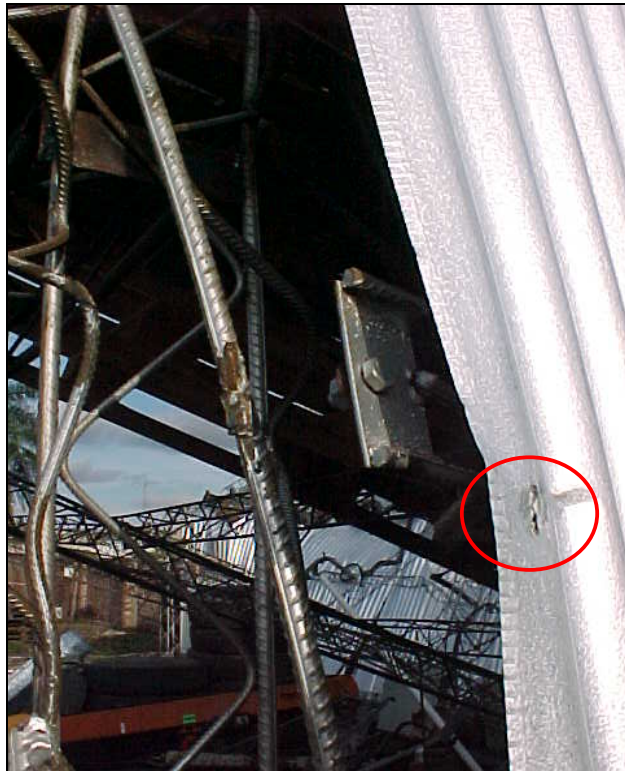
Falla en acero para hormigón armado soldado. Falta de arandela en fijación de la chapa (C&R).
